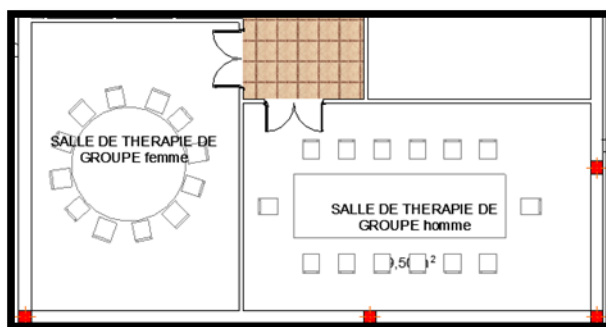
plan de salle de thérapies de groupe H /F de notre équipement
